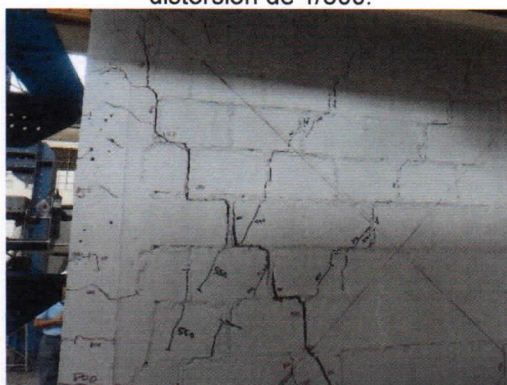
Formación de grietas diagonales en la parte superior central de la cara Norte para una distorsión de 1/300.
